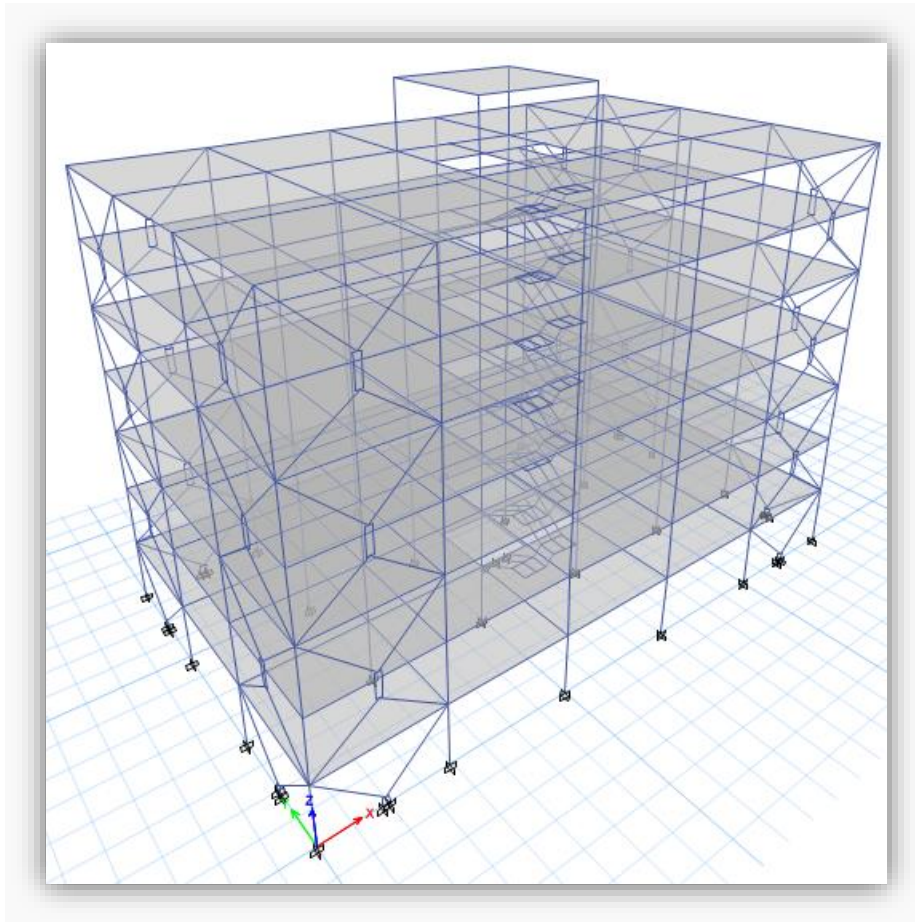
Vista en planta del modelo en ETABS
